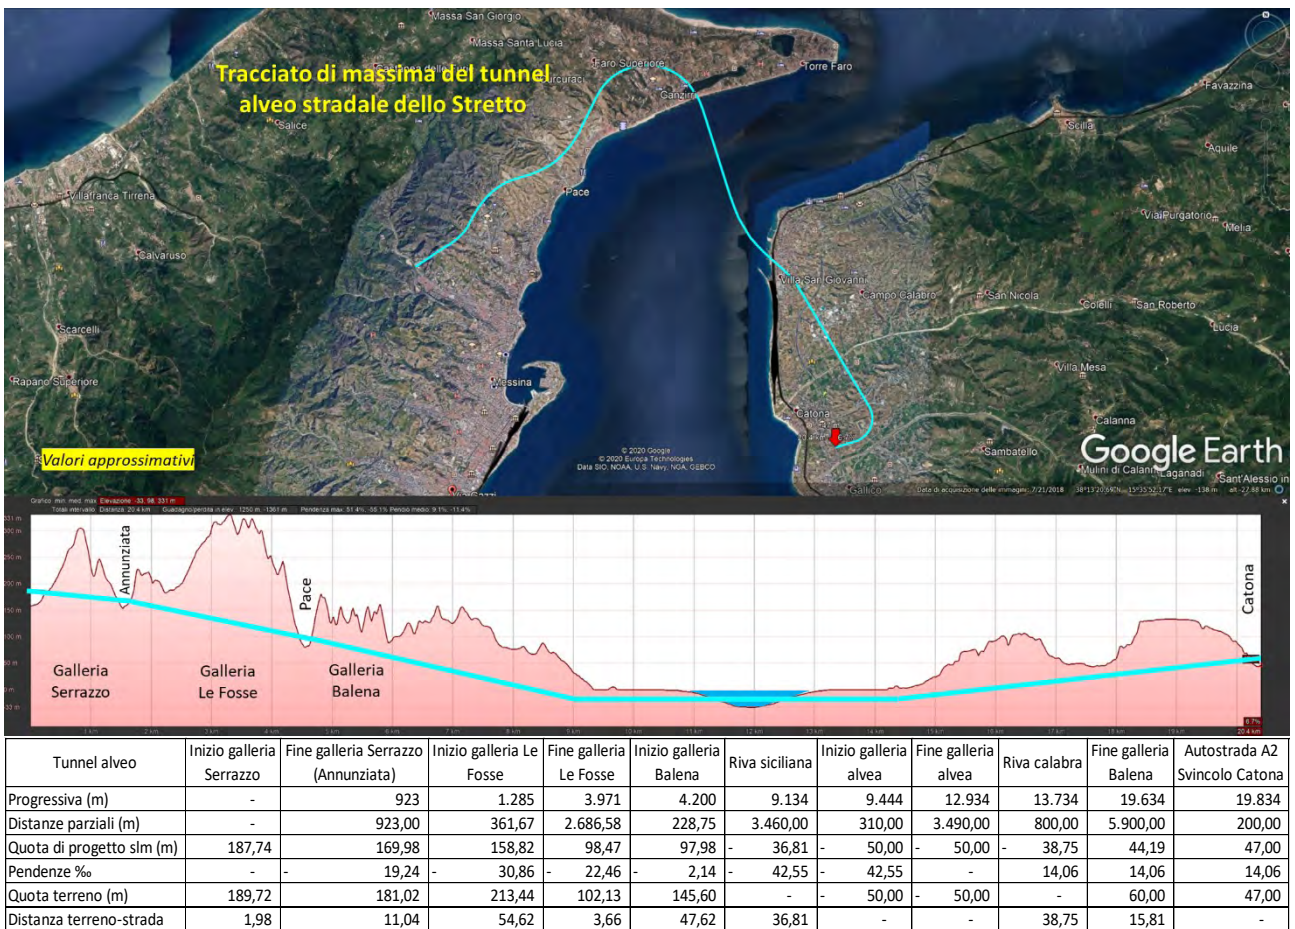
Tunnel alveo – tracciato autostradale – Caratteristiche plano-altimetriche
